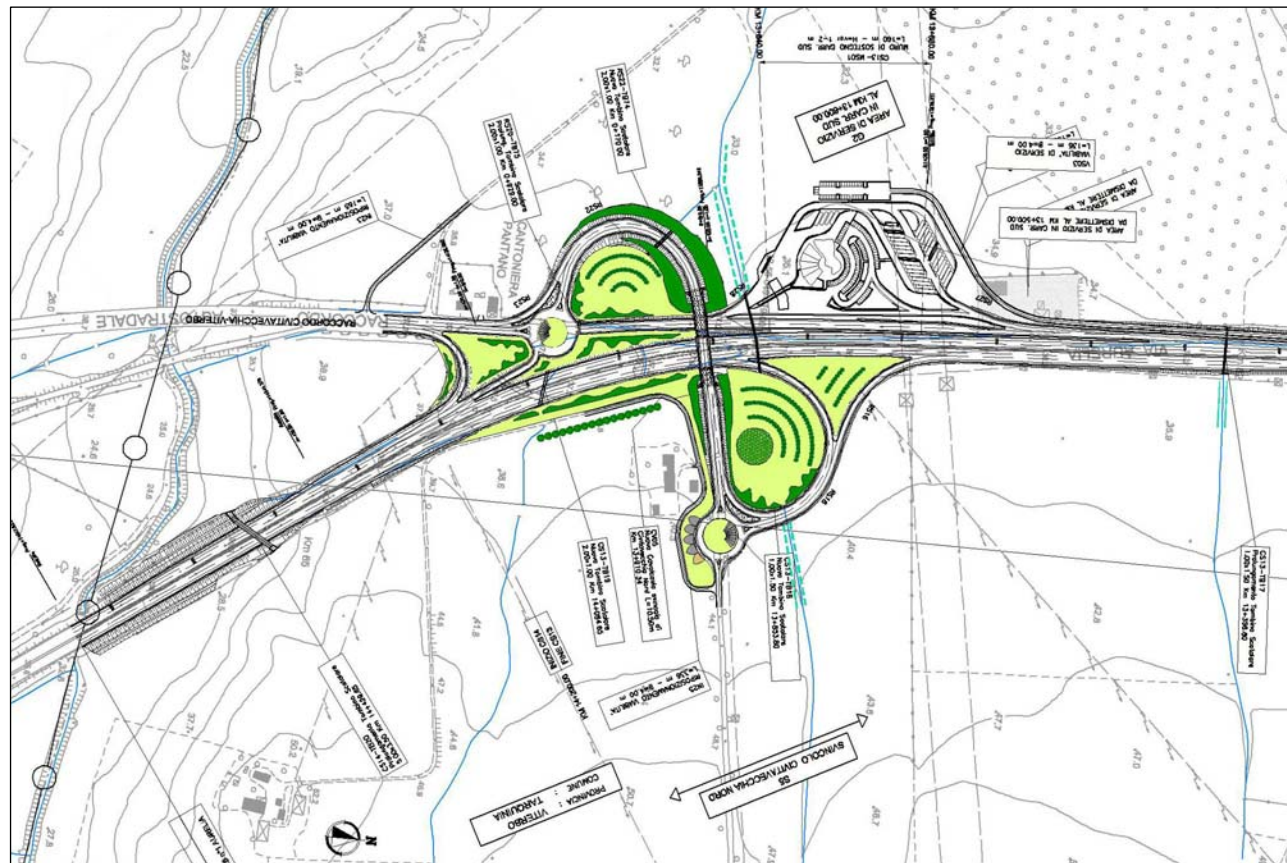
La planimetria di inserimento paesaggistico dell'AdS in carreggiata sud e dello svincolo per Civitavecchia.
